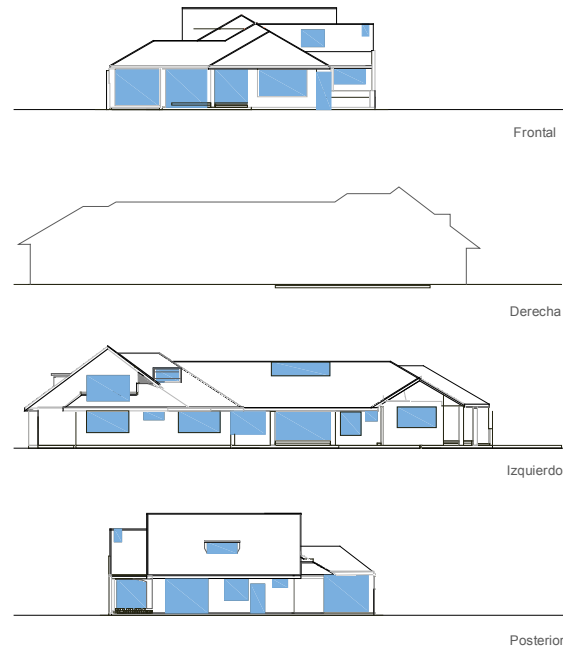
Representación de porcentajes de aberturas en fachadas de la vivienda 2.
